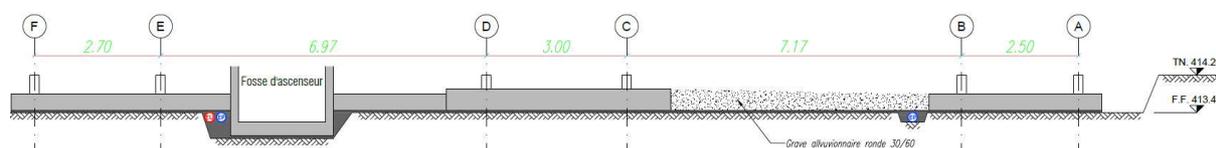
Coupe en travers des fondations du pavillon (source : concept d'évacuation des eaux, P&M, mai 2021 – Annexe 5.5.d)
